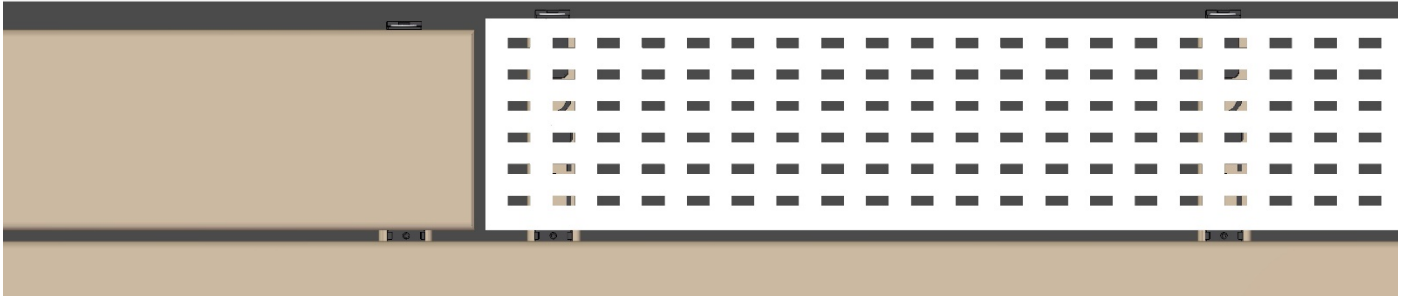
Die unterschiedlichen Breiten der Terrassendielen und des Drainageprofils müssen immer an den Übergängen berücksichtigt werden. Für die Montage des Drainageprofils mit dem Start-Clip müssen die Unterkonstruktionen 8 mm länger sein. Dafür kann der Abstand zur Hauswand von 20 mm auf 12 mm reduziert werden. Alternativ können Sie den Entwässerungsrost auch auf der gesamten Breite der Terrasse einbauen.
